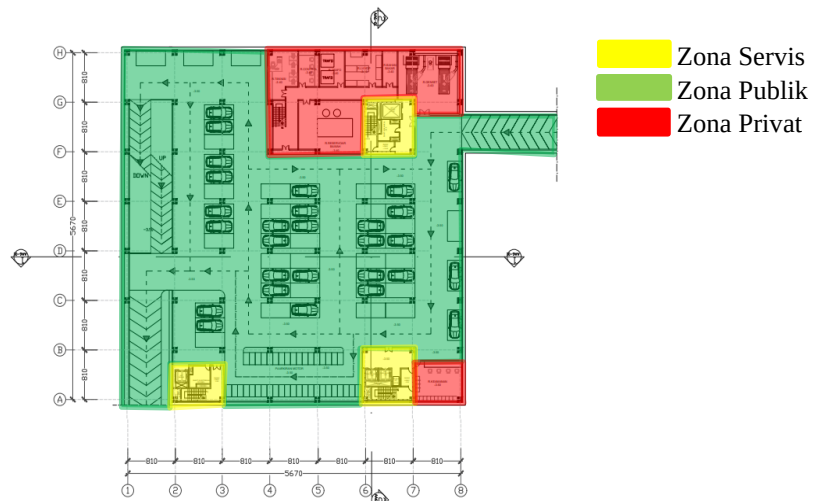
Zoning dan sirkulasi lantai 3 apartemen
